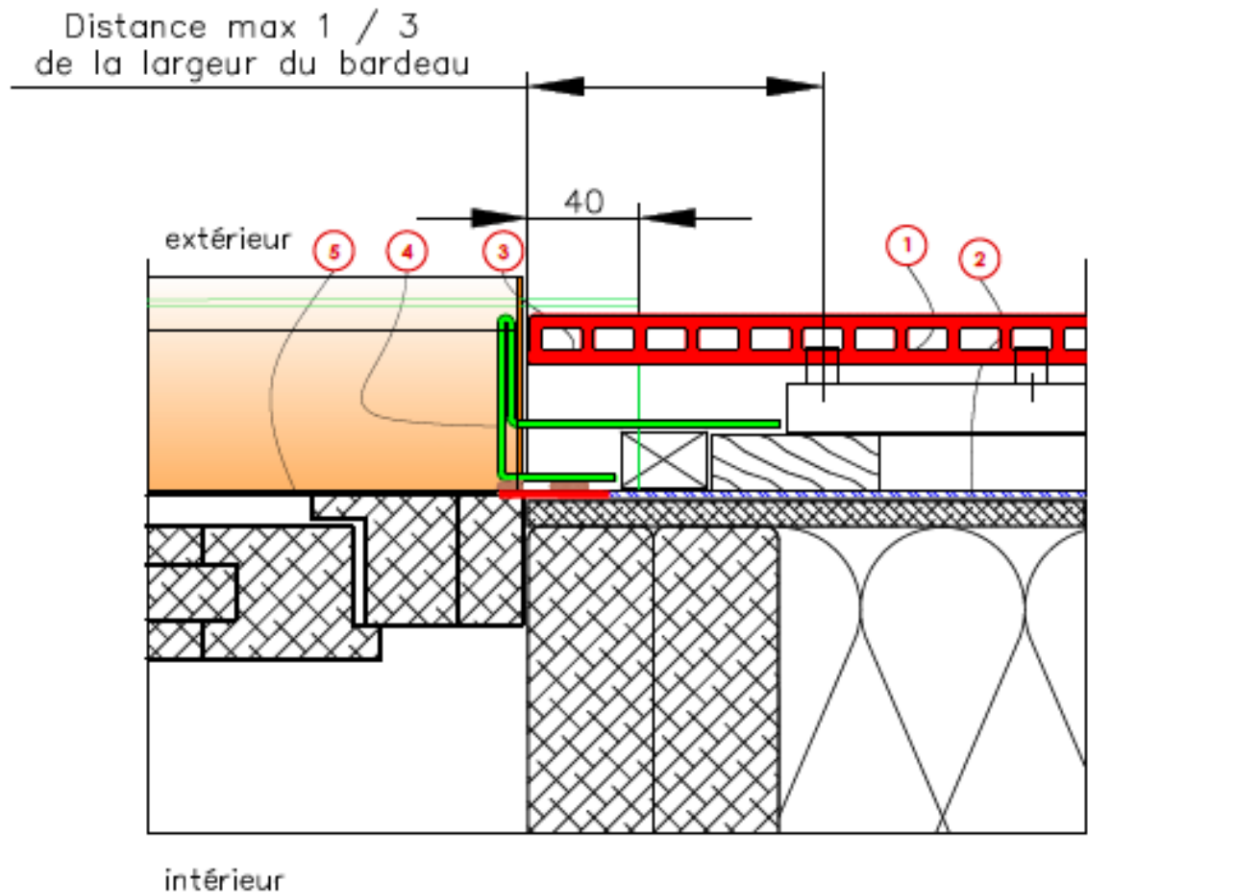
Pose à joints fermés – Coupe sur linteau de baie
